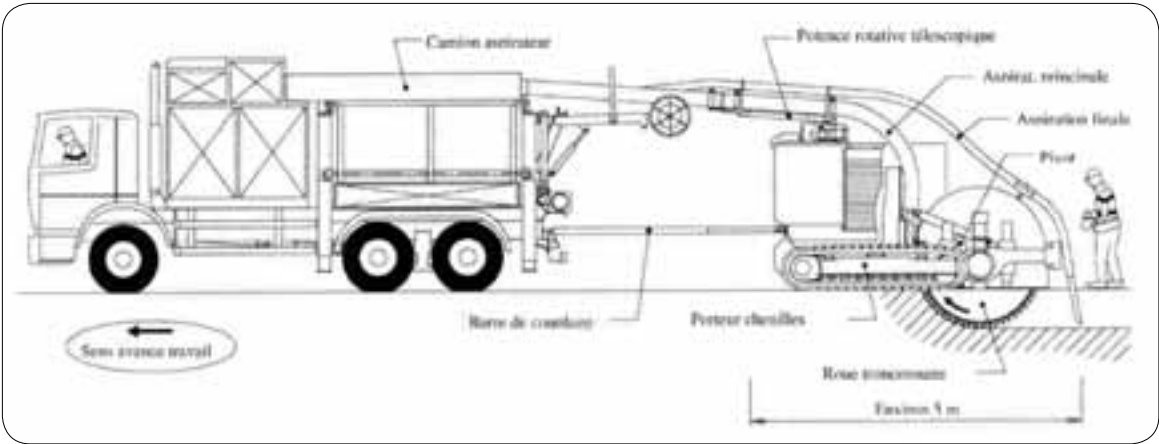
schéma technique de la machine de micro-tranchage sous chaussée ou trottoir
